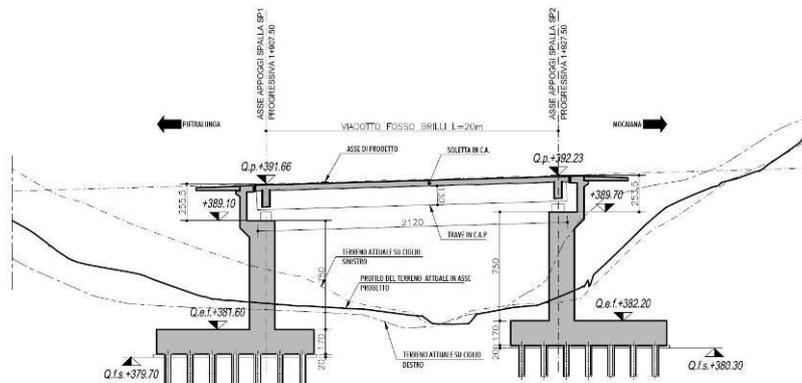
SEZIONE LONGITUDINALE VIADOTTO FOSSO BRILLÌ
